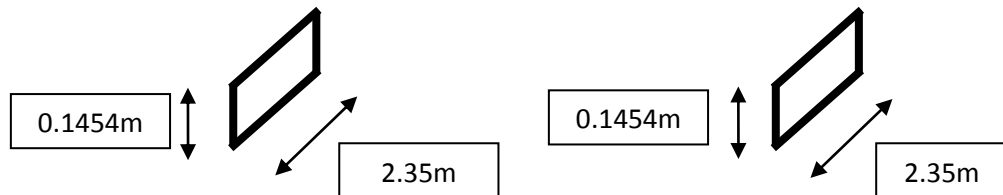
Detalle de armado longitudinal de hierro para cimentación
